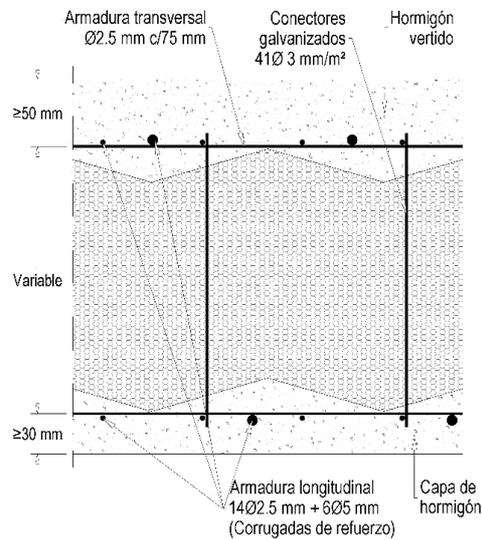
Sección transversal del panel de muro portante (BSR)
